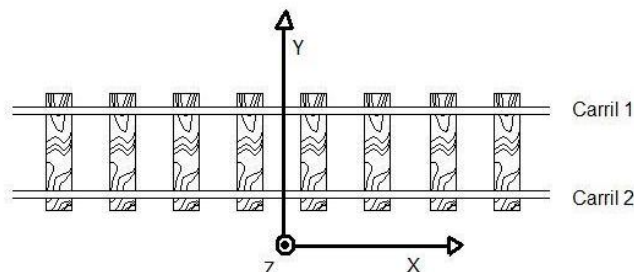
Vista em planta dos carris e orientação dos eixos
